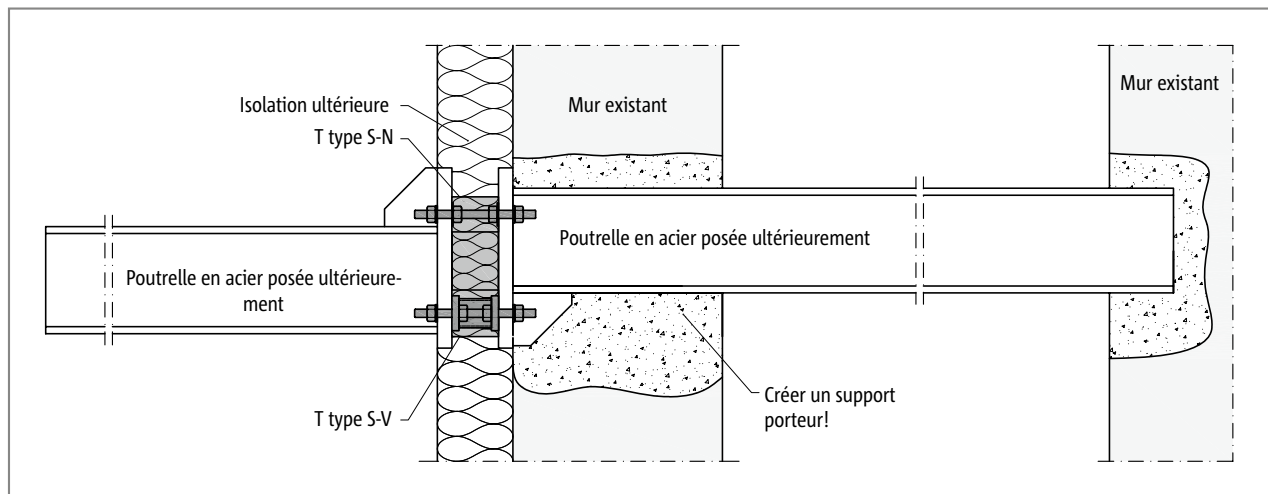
Schöck Isokorb® T type S-N et T type S-V : balcon en acier en porte-à-faux libre posé ultérieurement ; raccordé à des poutres en acier installées ultérieurement avec décalage en hauteur
